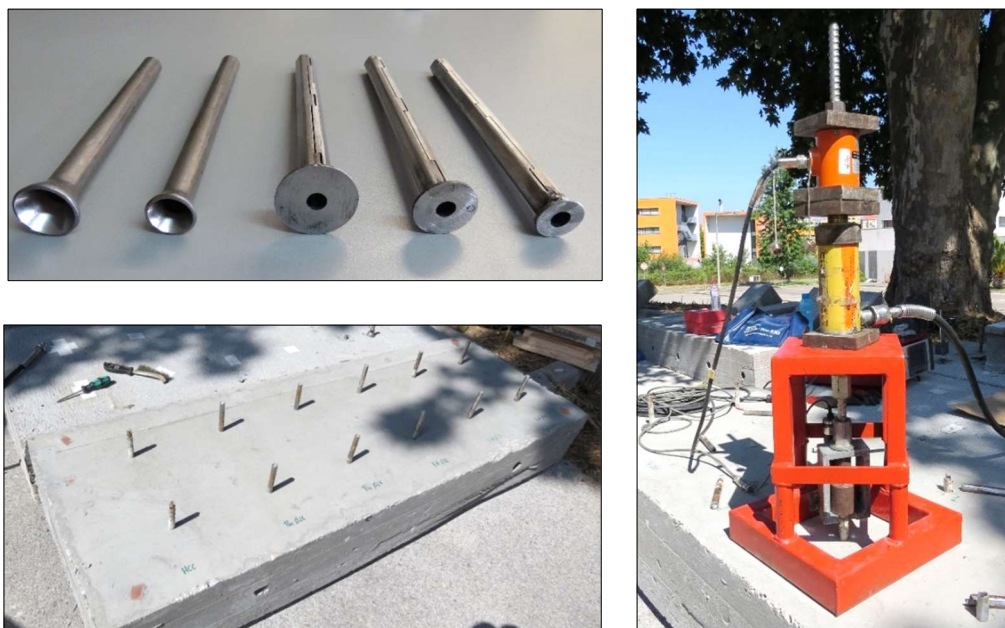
Provetes a ensaiar, configuração do sistema de aplicação de carga e aspeto final da laje utilizada ensaios da série ACC (arrancamento de conectores do lado da cabeça).
